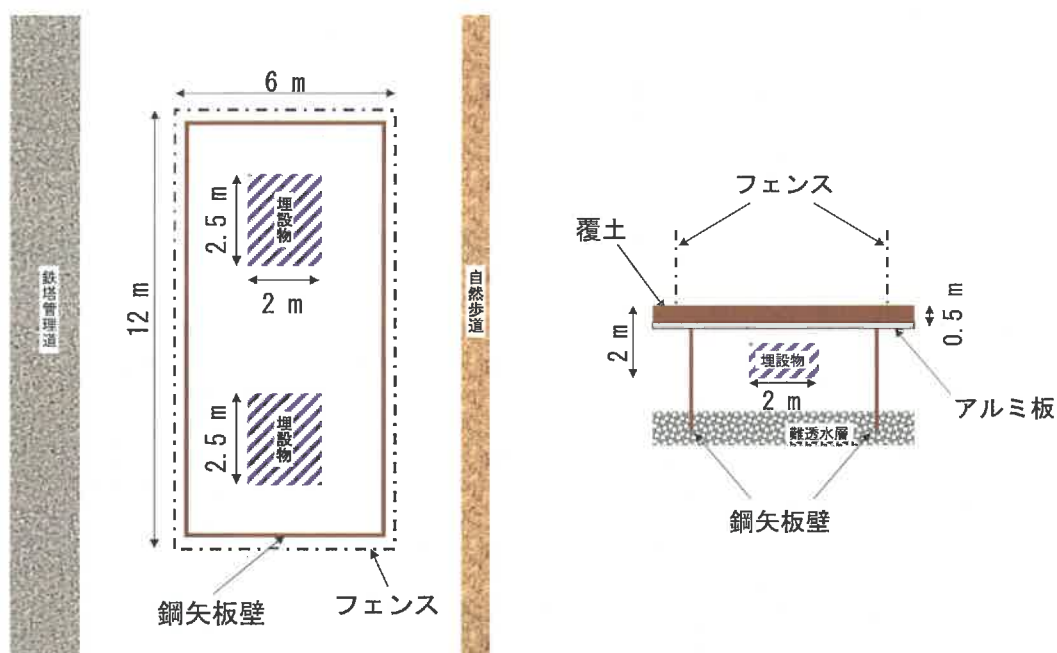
埋設状況想定図（左：平面図，右：断面図）（図 3-4 を再掲）
